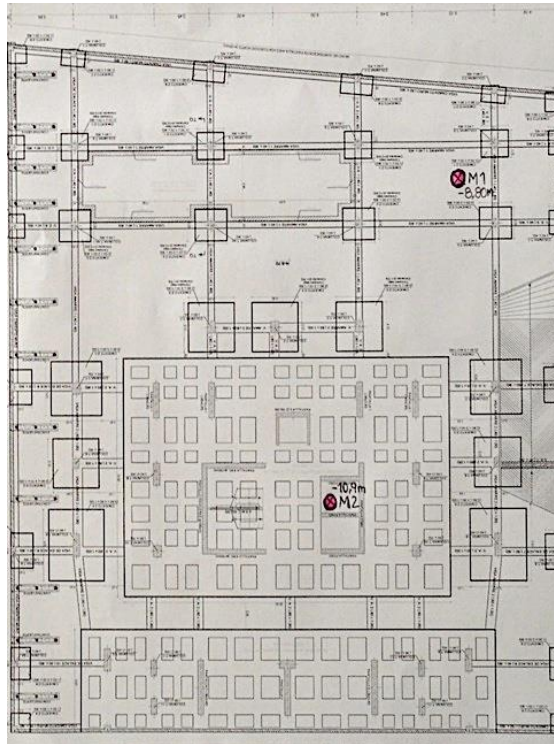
Plano en planta (Localización de muestreos M1 y M2).
